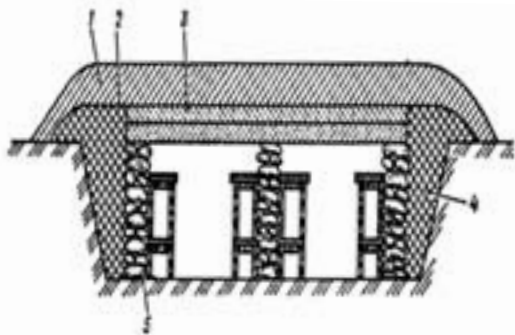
Швидкоспоруджуване сховище зі стінами із ґрутонабивних мішків і перекриттям із залізобетонних плит: 1 – насипний ґрунт; 2 – гідроізоляція; 3 – залізобетонна плита; 4 – ґрунт, утрамбований пошарово; 5 – мішки із ґрунтом.
